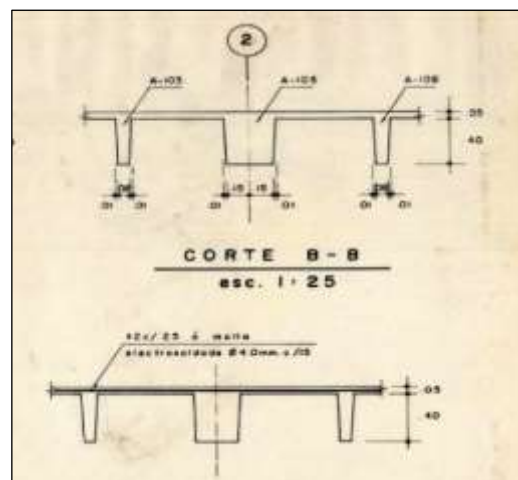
Fuente: autores,, (2018). Detalle de plano de placa aligerada, planos originales alcaldía por Ing. Carlos Navas Camargo.
